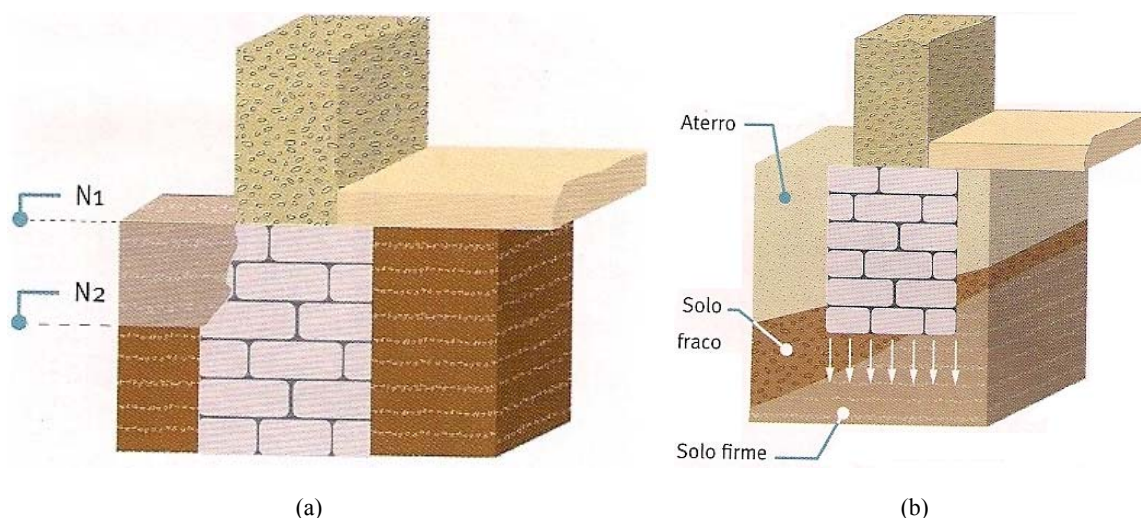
(a) degradação de fundações expostas na sequência de escavações, N1 - Conta inicial do terreno/N2 - Cota após rebaixamento; (b) fundação sobre aterro/solo de fraca qualidade [1].
